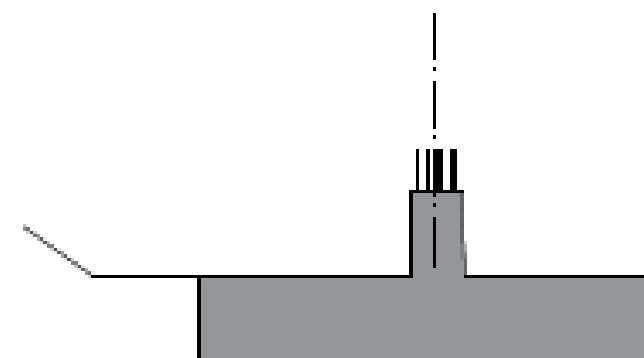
Armadura de espera en las cimentaciones para la construcción de los estribos.
